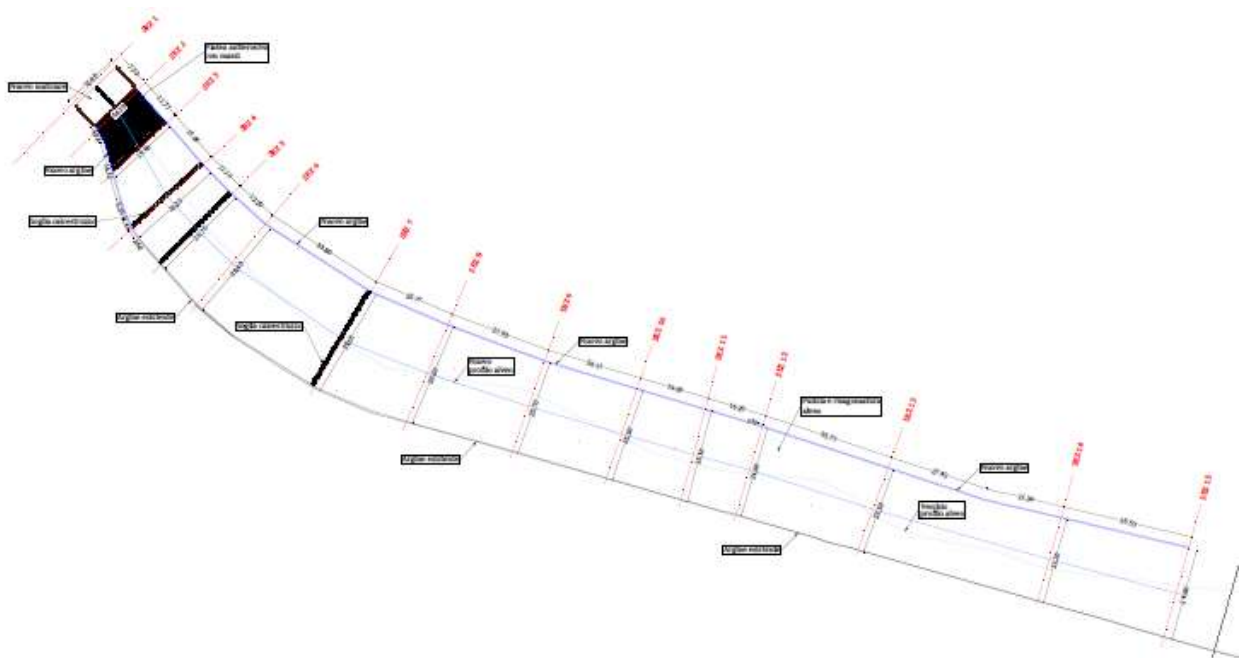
Planimetri ubicazione interventi. 1° Intervento
